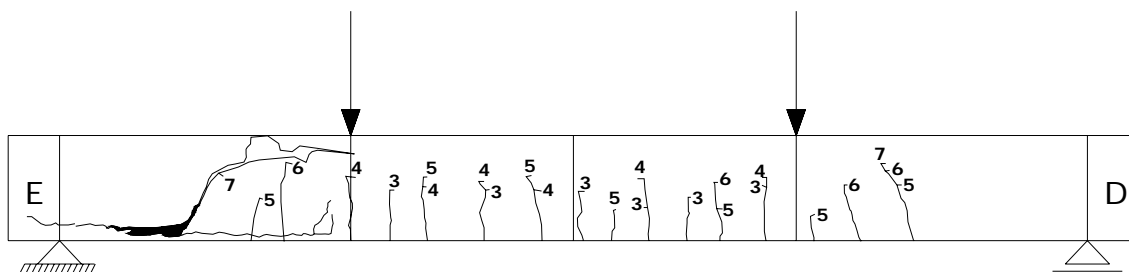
Padrão de fissuração para a viga V80-1 sem armadura transversal
